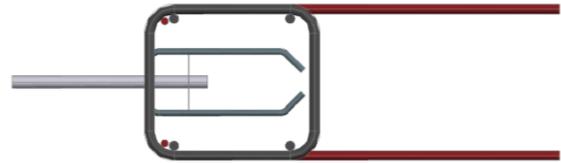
Disposición de armaduras de suspensión con estribos. Alzado.
